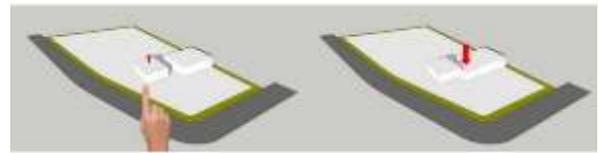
Batasan GSB sebagai landasan *Site Back
